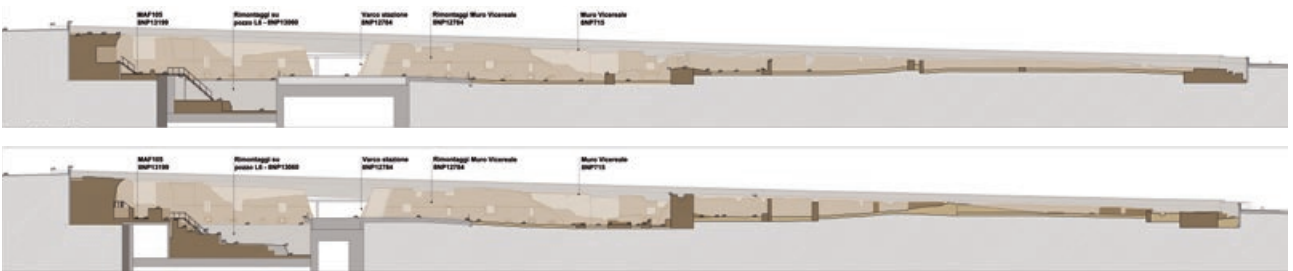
Sezione longitudinale guardando il muro della seconda cinta muraria vicereale del XVI sec. Longitudinal section looking at the wall of the second viceregal wall from the 16th century.
